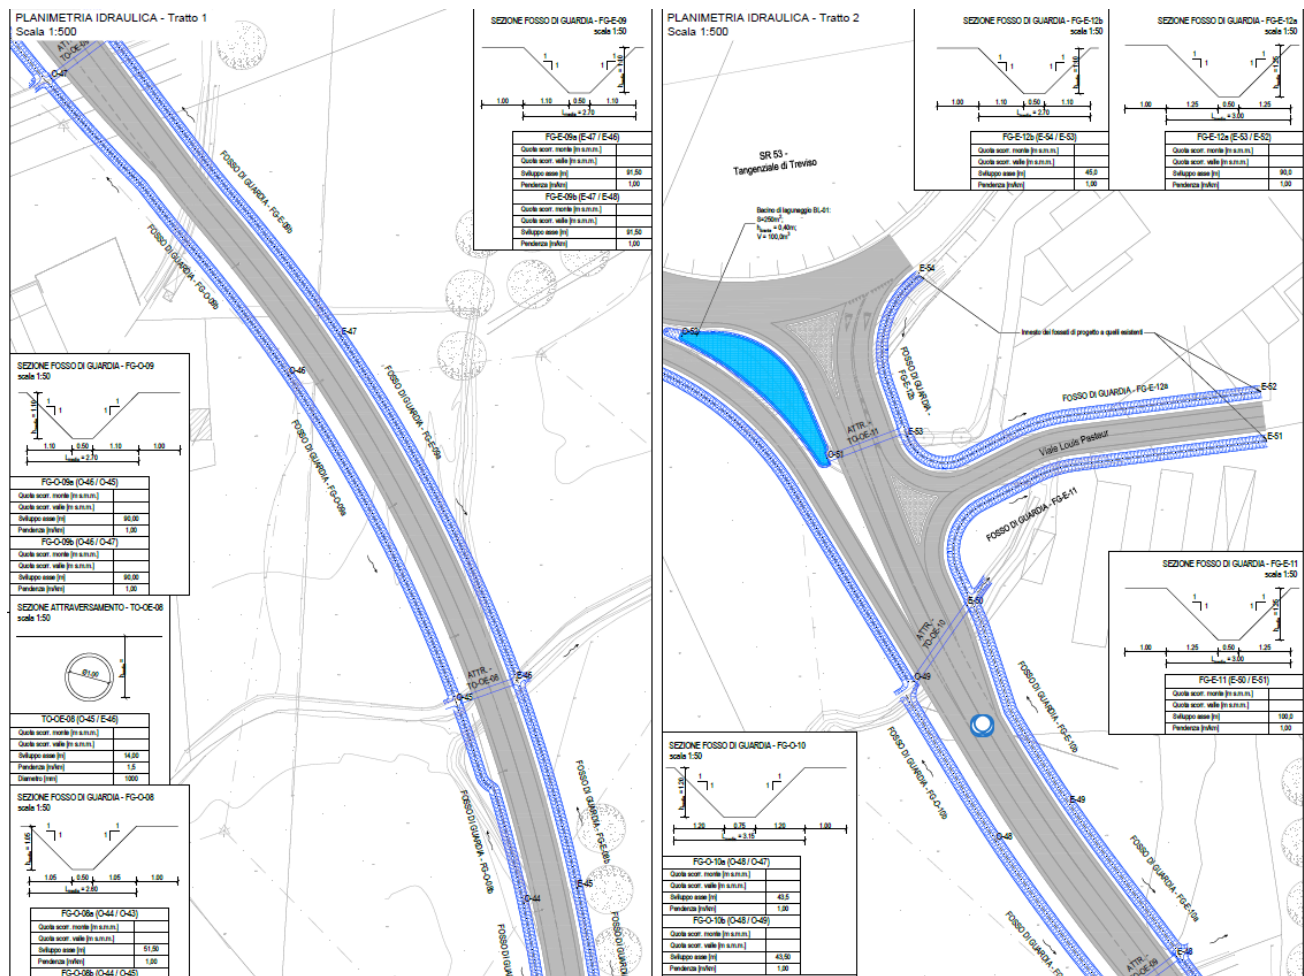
Stralcio planimetria idraulica nella zona di collegamento con Tangenziale di Treviso
